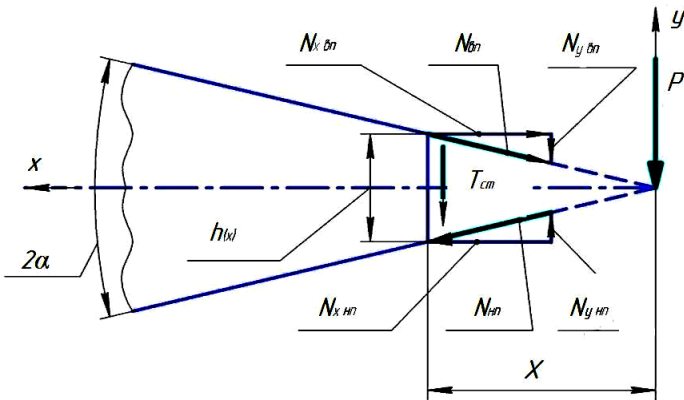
Внутренние усилия в поперечном сечении балки с наклонными поясами, индексы: *вп* – верхний пояс; *нп* – нижний пояс
